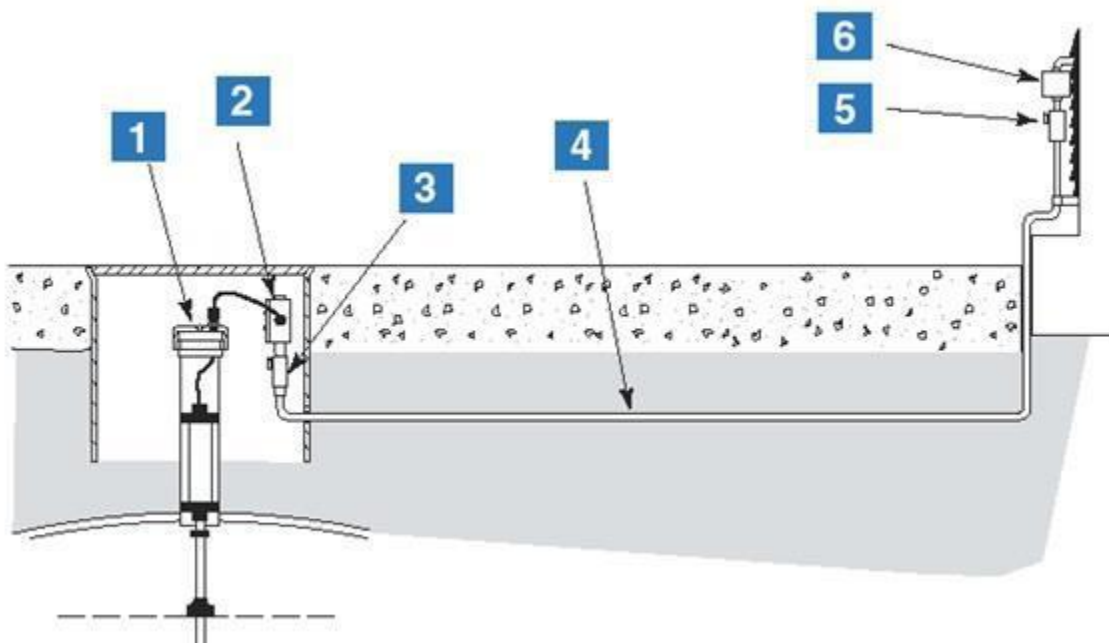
Пример прокладки кабеля зонда в жестком кабелепроводе, проходящем в грунте
